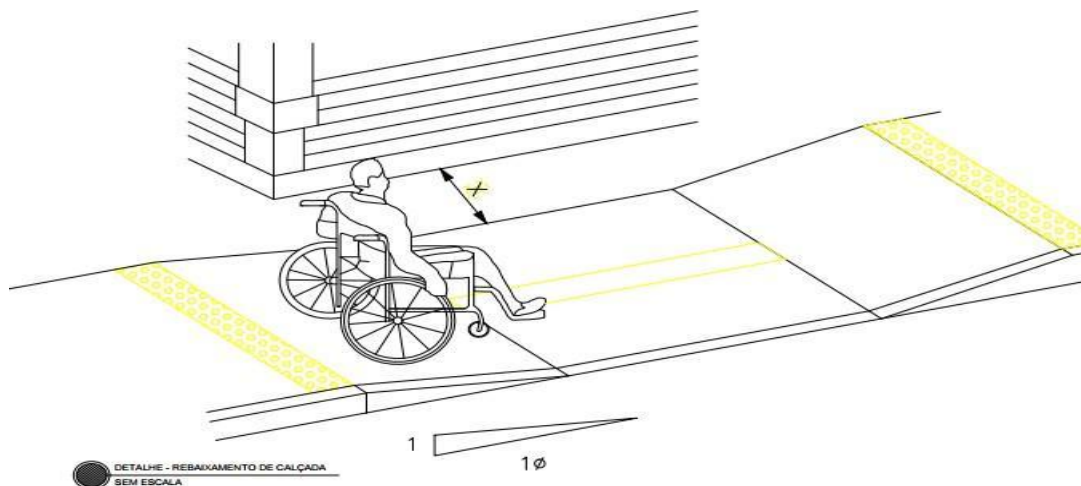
DETALHE REBAIXAMENTO DA CALÇADA
